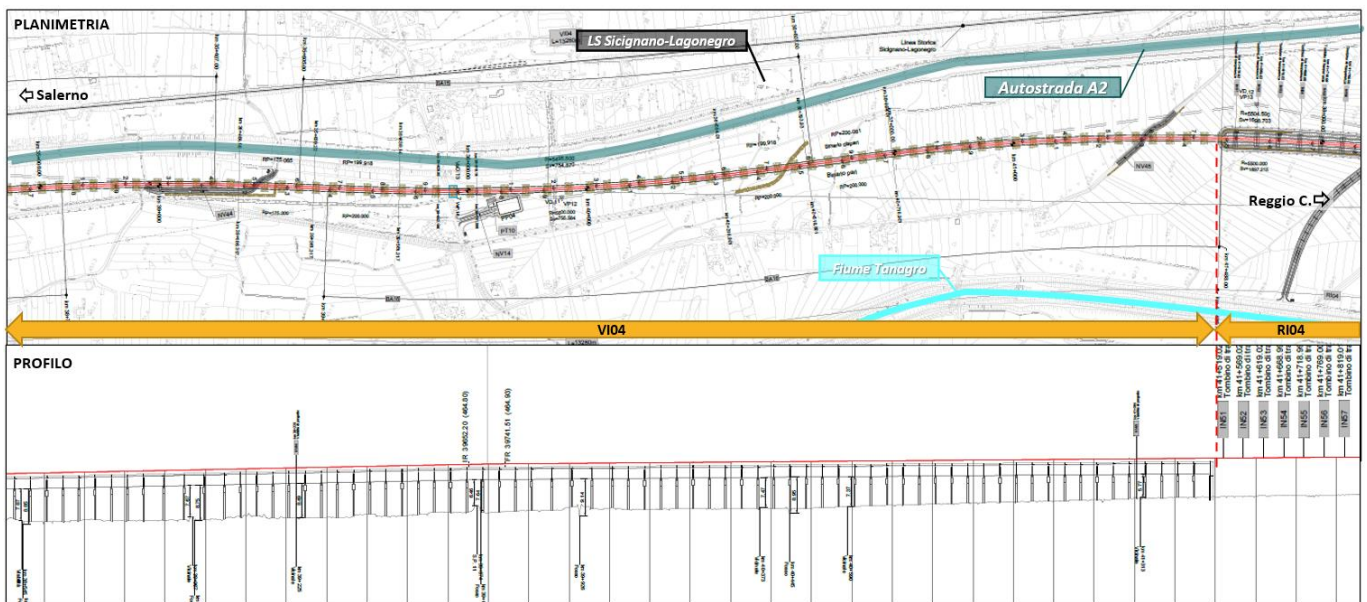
Planoprofilo di progetto da km 39+300 a km 41+486
